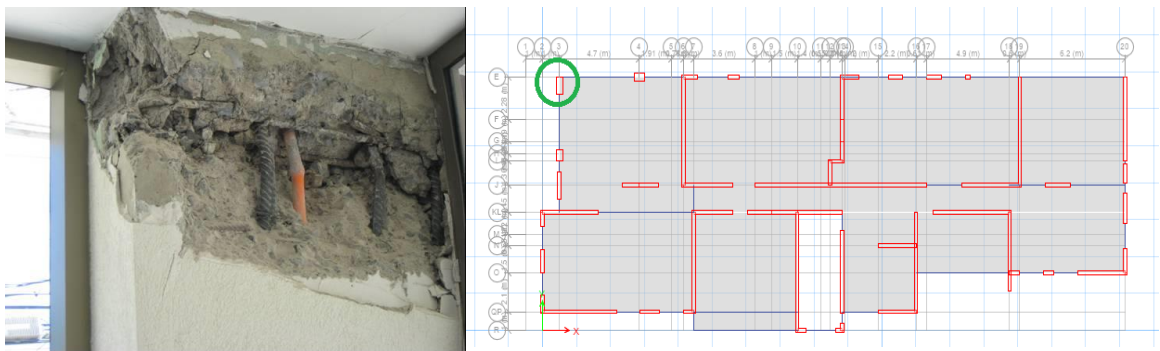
Imagen del daño y ubicación en planta del elemento N1-1
